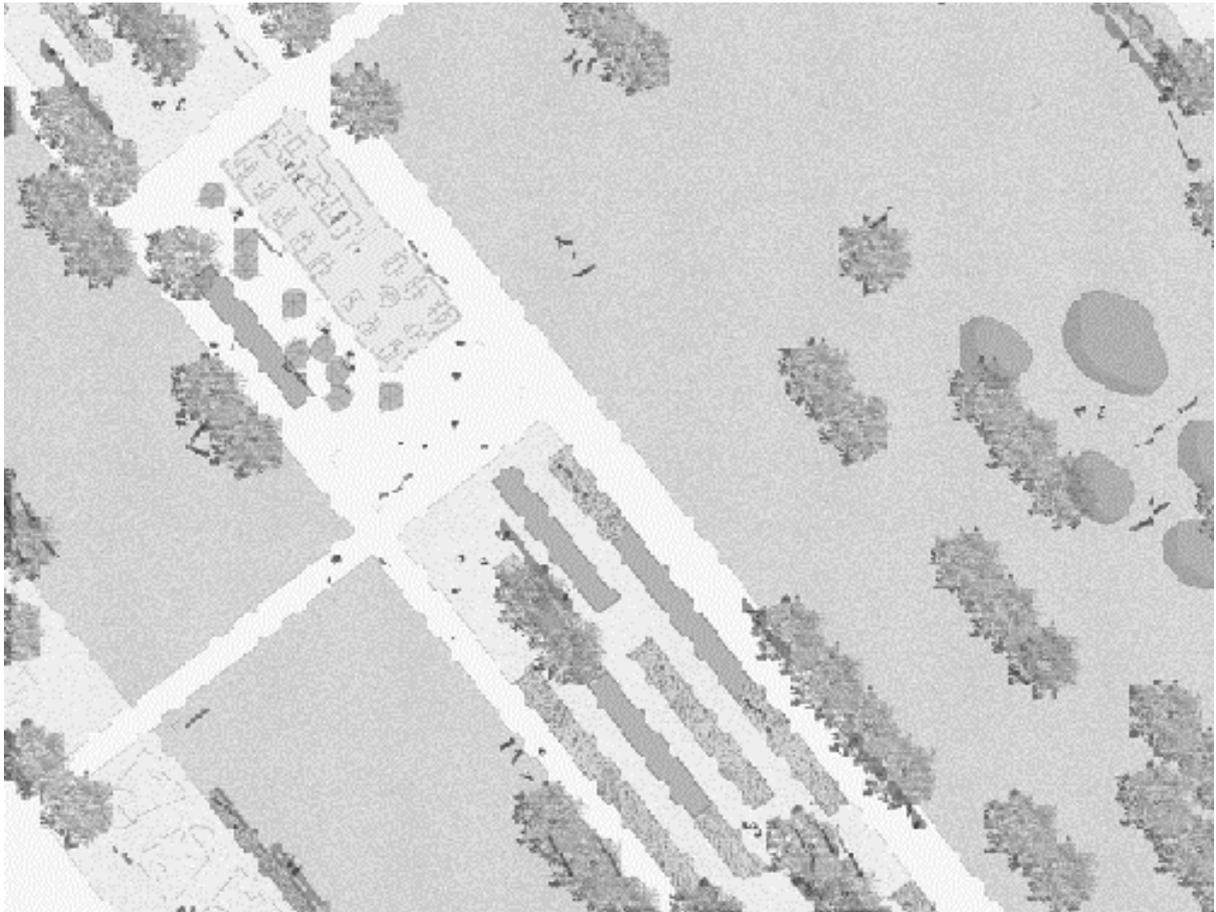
genordeter Wettbewerbsentwurf 2006, ‚Hager & Partner – Zürich‘, Grundriss des Caféhauses – ‚blauer Diamant‘
